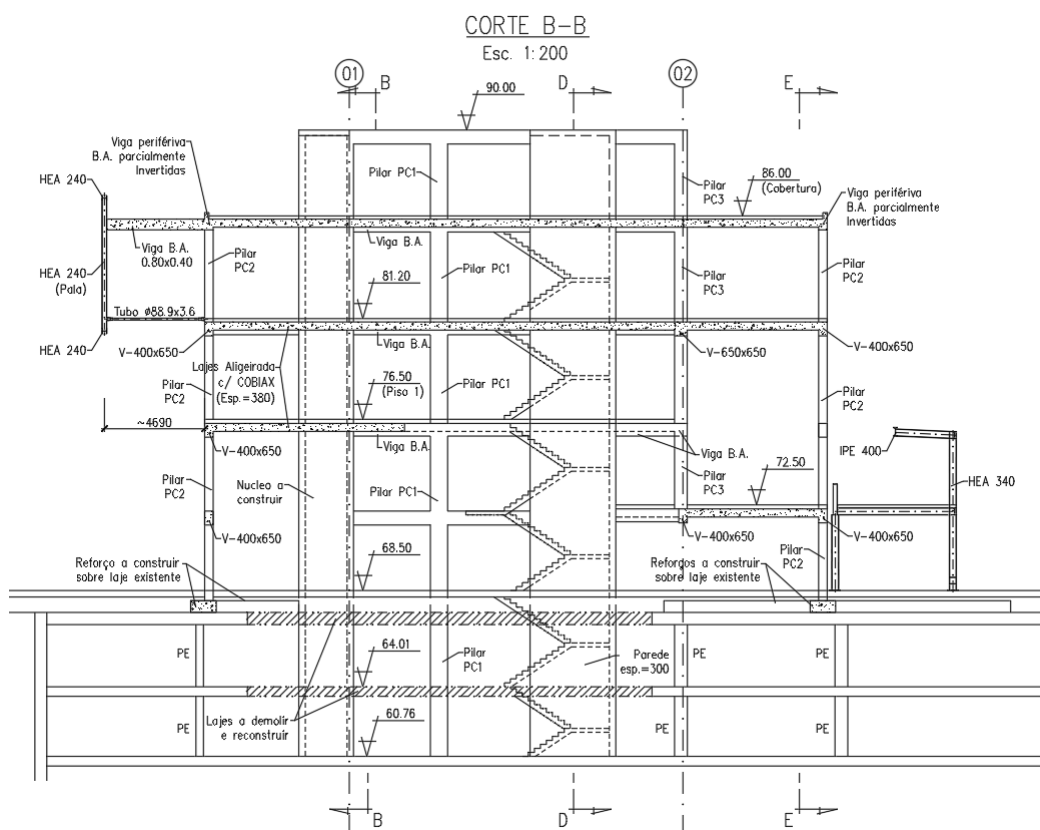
Bloco de acessos verticais a ponte: Corte transversal.
